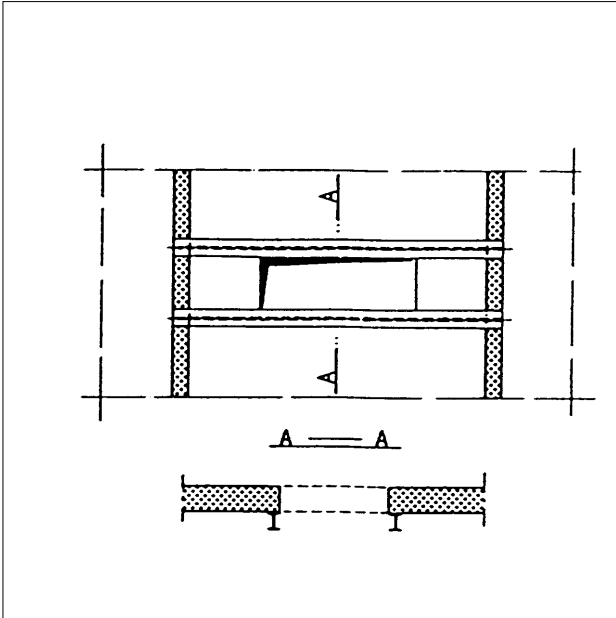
Dalle en béton/création d'une ouverture; renforcement par une mise en place de profilés en acier.
